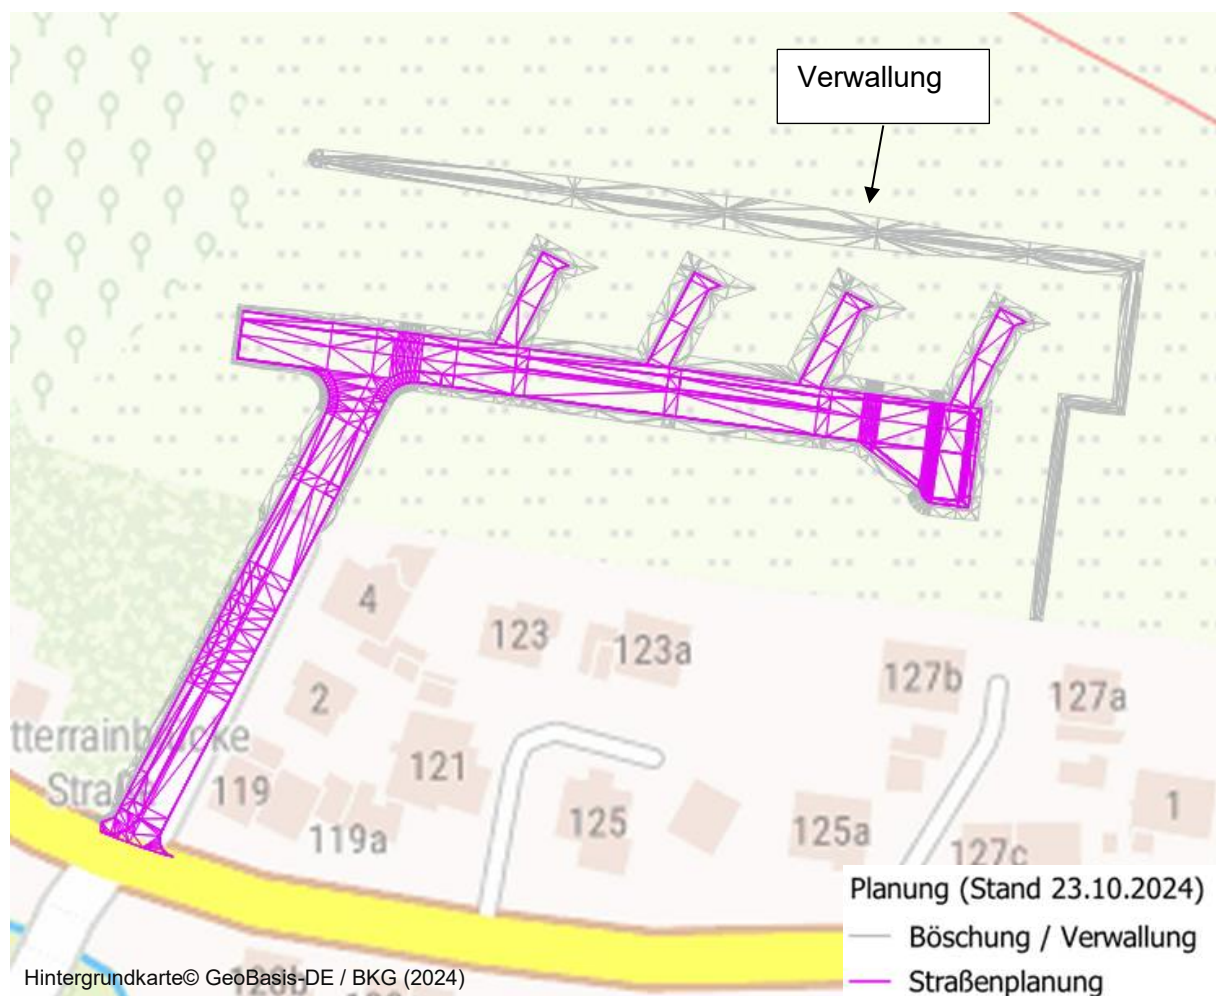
Lageplan betrachtete Strukturen des geplanten Bauvorhabens Hausmatte
